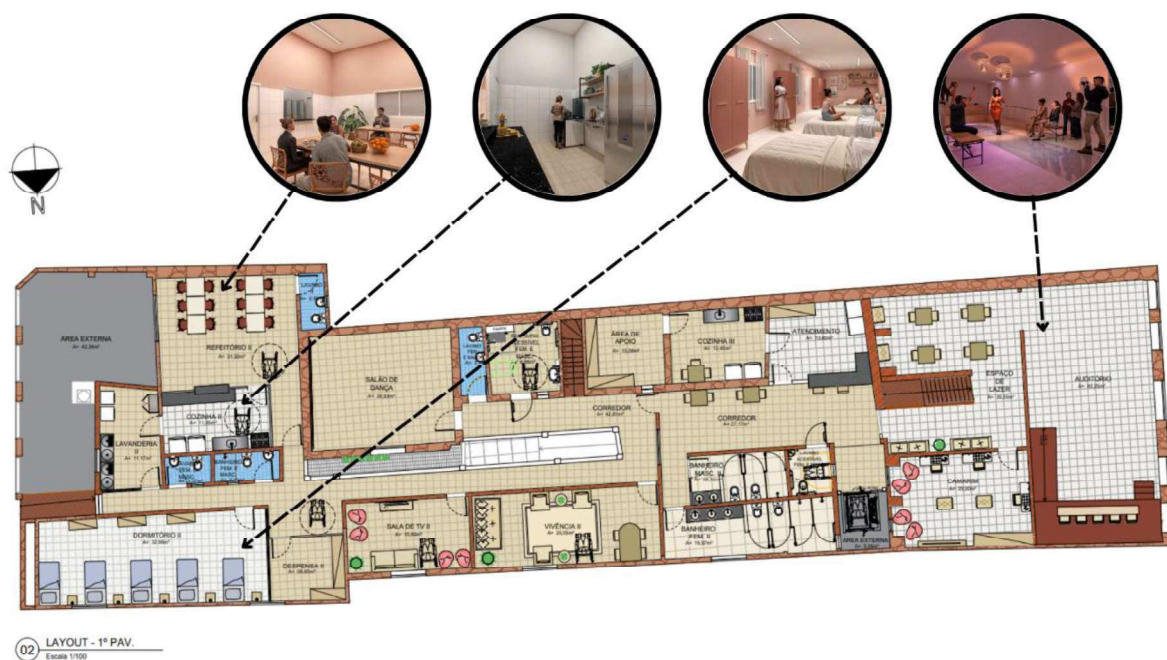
Esquema do 1º Pavimento. Fonte: Autora, 2024.
